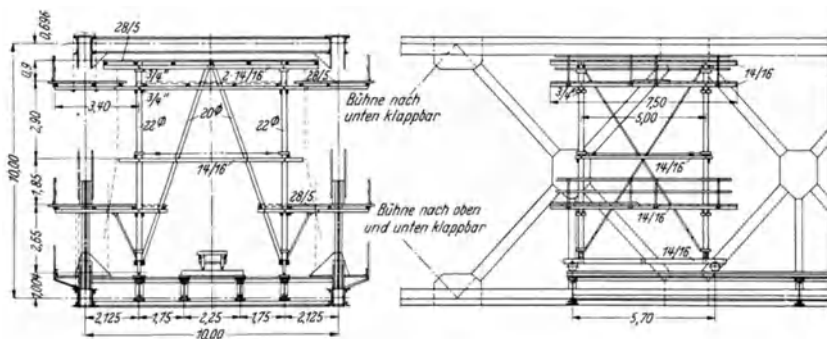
Fahrbares Nietgerüst beim Bau der Rheinbrücke Ludwigshafen- Mannheim.
